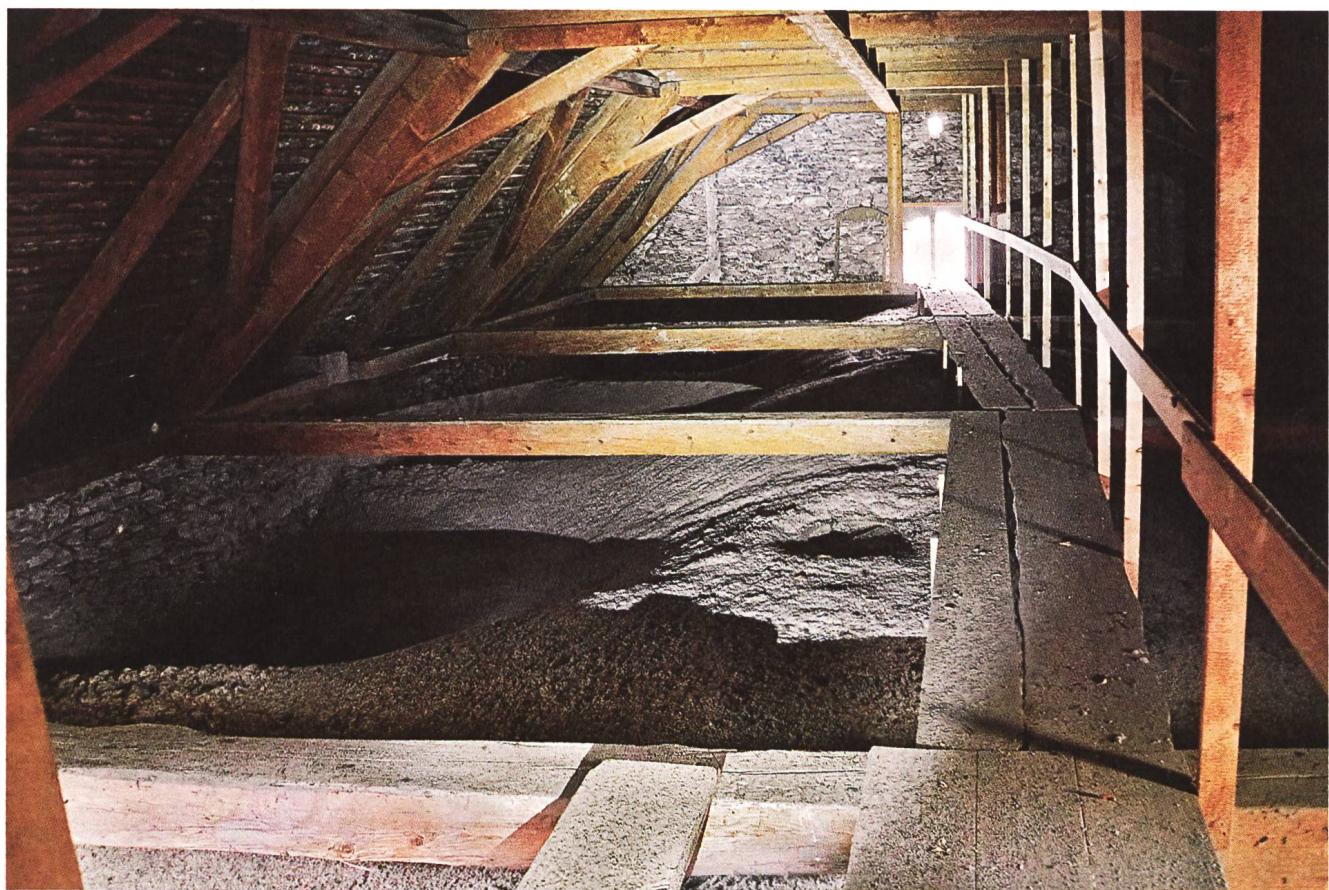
Blick in den Dachstuhl der ref. Kirche von Thusis nach Westen mit Aussparungen der alten Dachkonstruktion in der Giebelwand.
